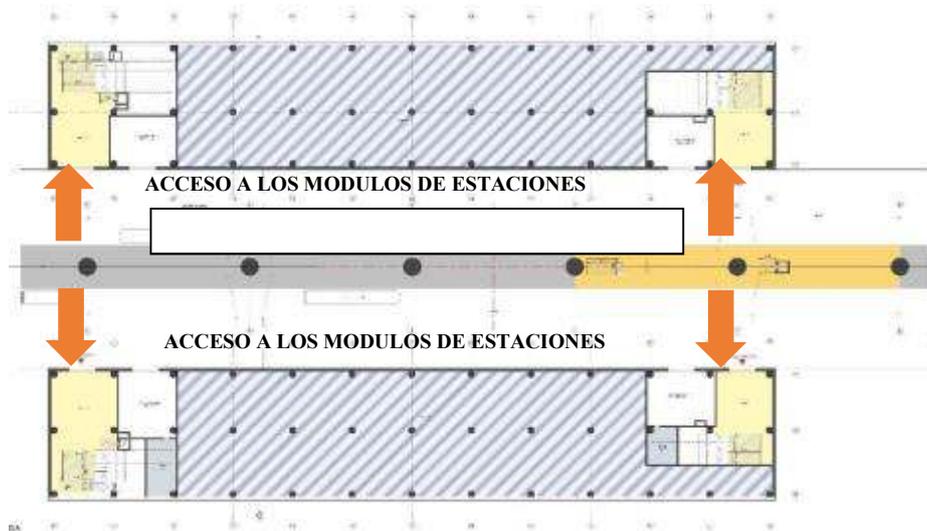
Planta baja de una estación interconexión. Fuente: Elaboración propia
